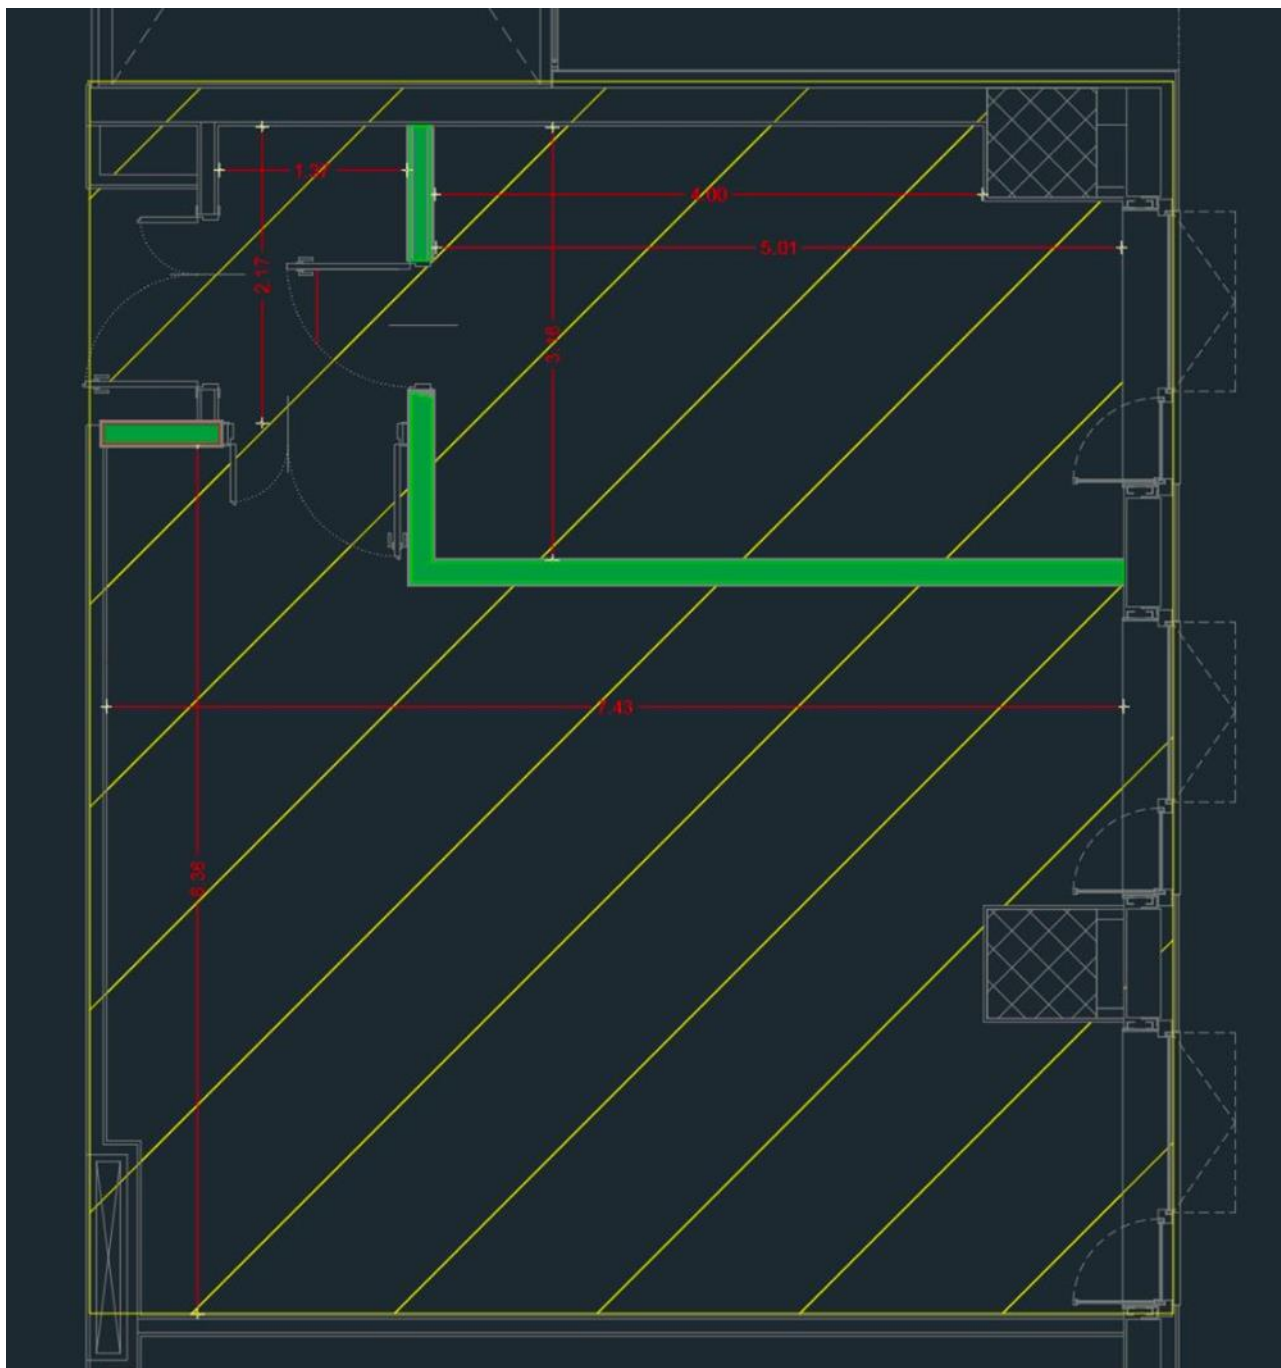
Particolare planimetrico dei locali (contrassegnati con campitura gialla) destinati all'installazione della CAVE (tratto dal file "PIANTE LOCALI.dwg" allegato alla presente documentazione)
